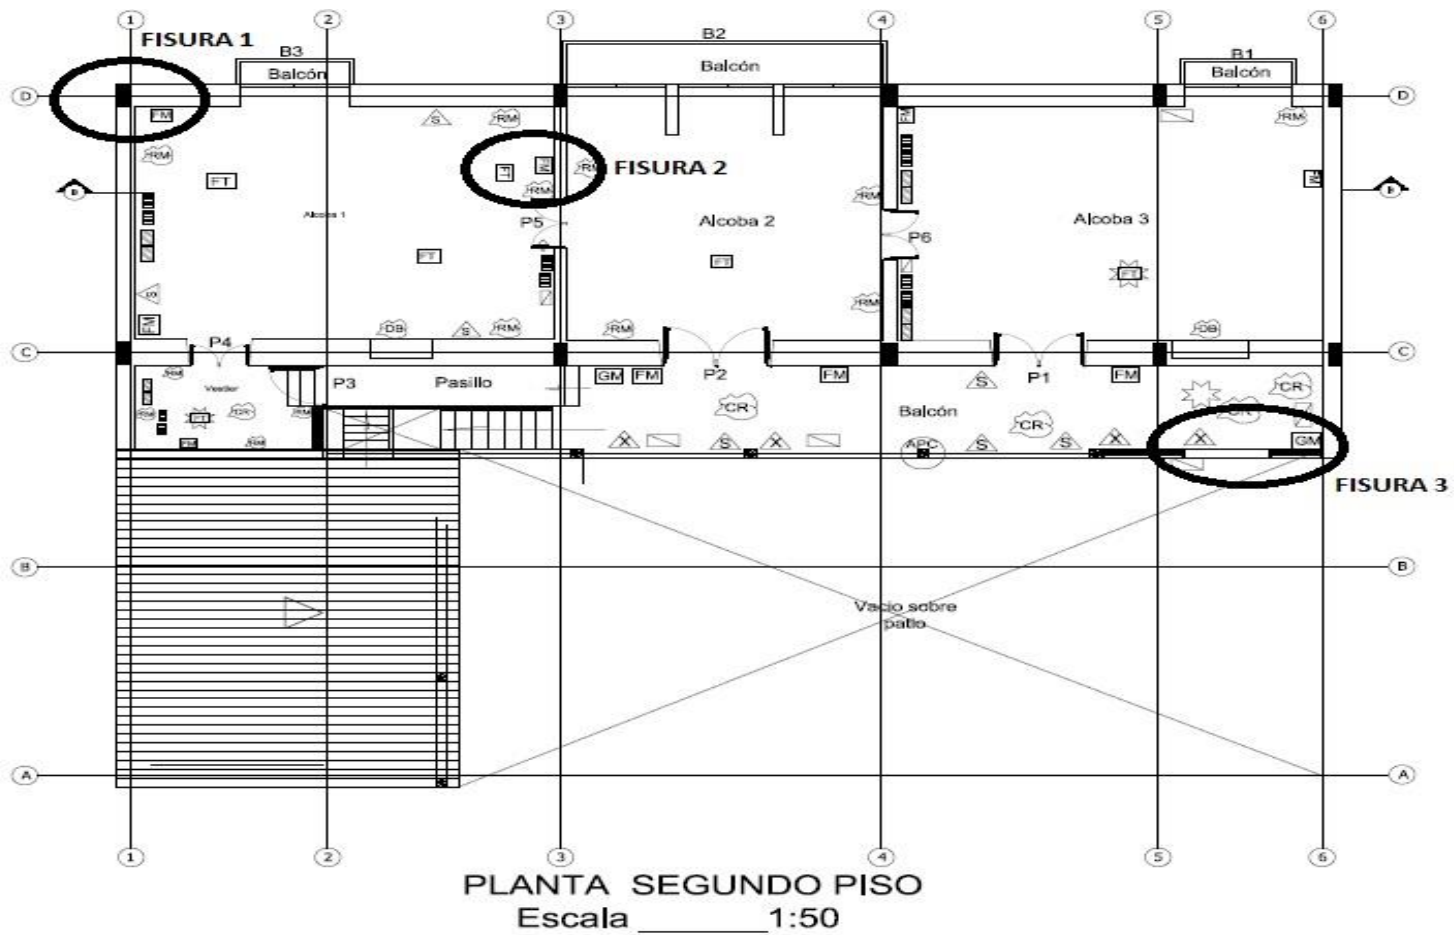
Plano de lesiones, indicando las fisuras a estudiar (marcadas con el círculo negro)
